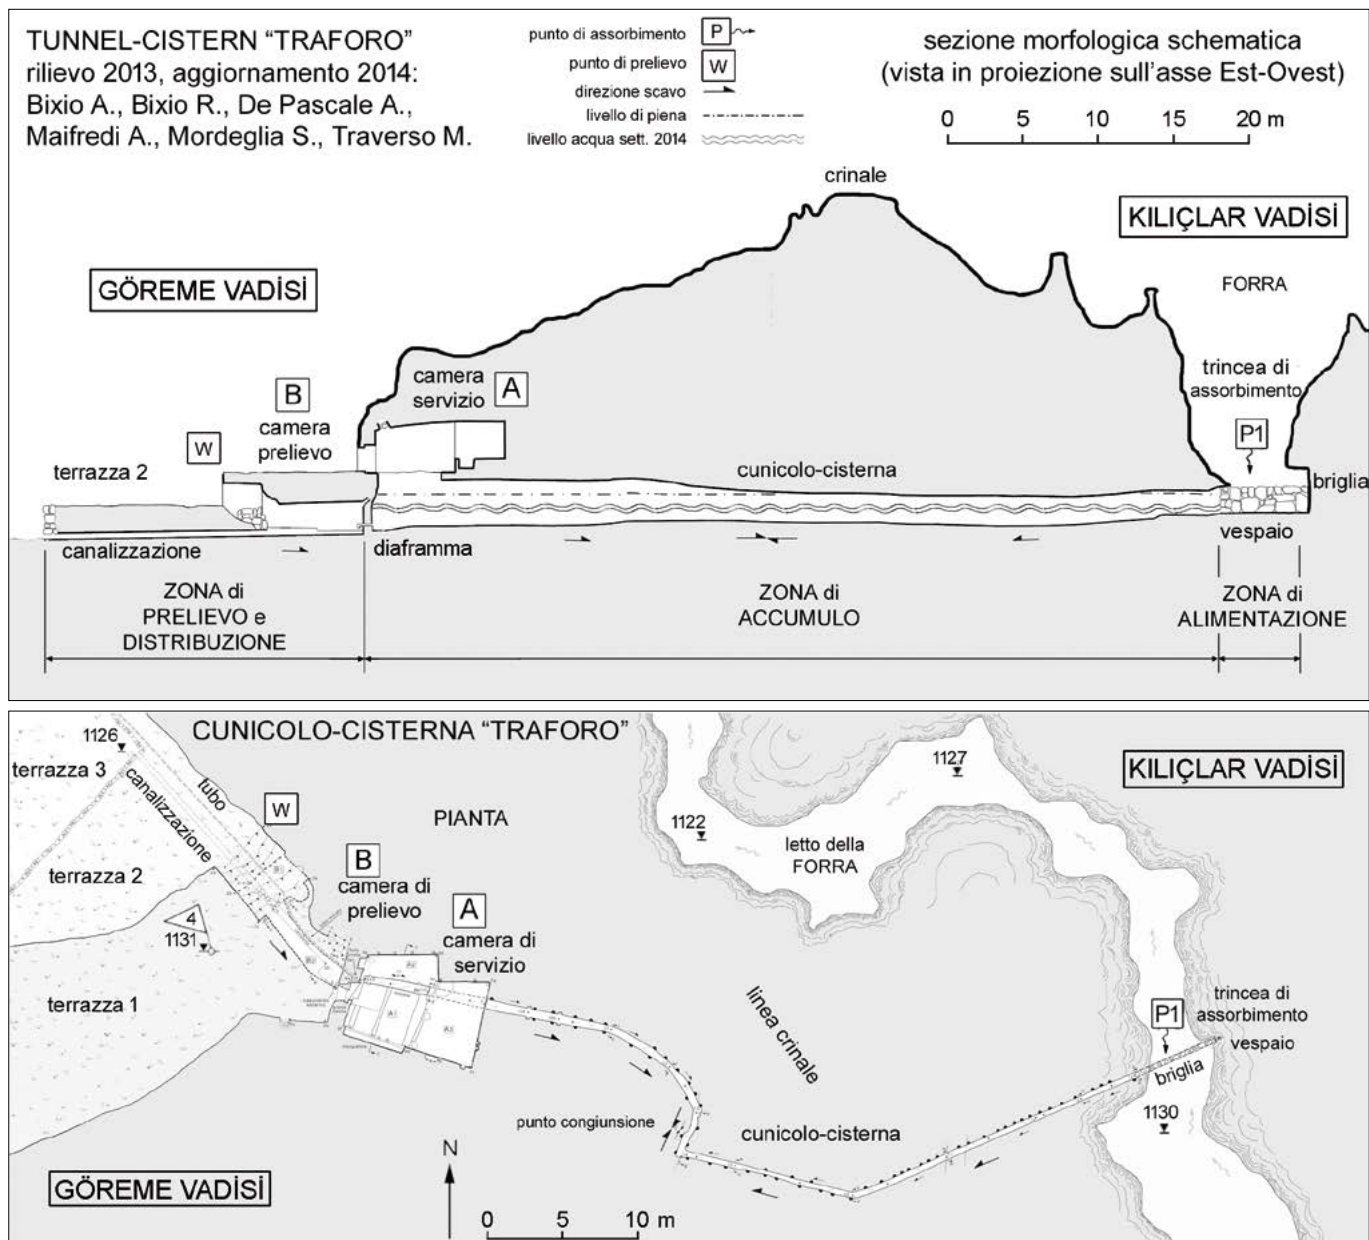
Sezione longitudinale e pianta del cunicolo-cisterna "Traforo" (grafica R. Bixio)
